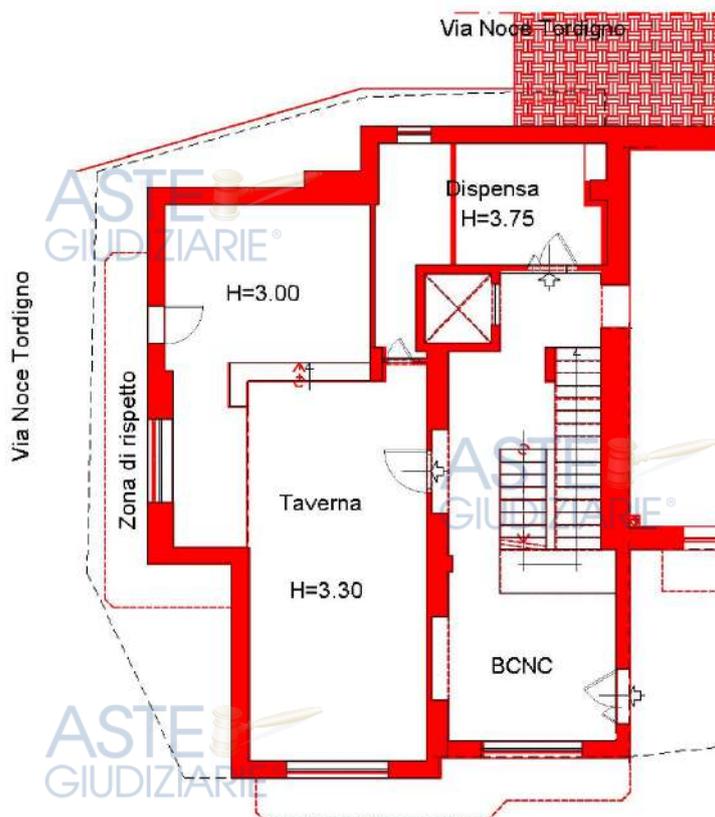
Sovrapposizione planimetrie catastali su rilievo stato di fatto (in rosso) - Lotto Cinque
